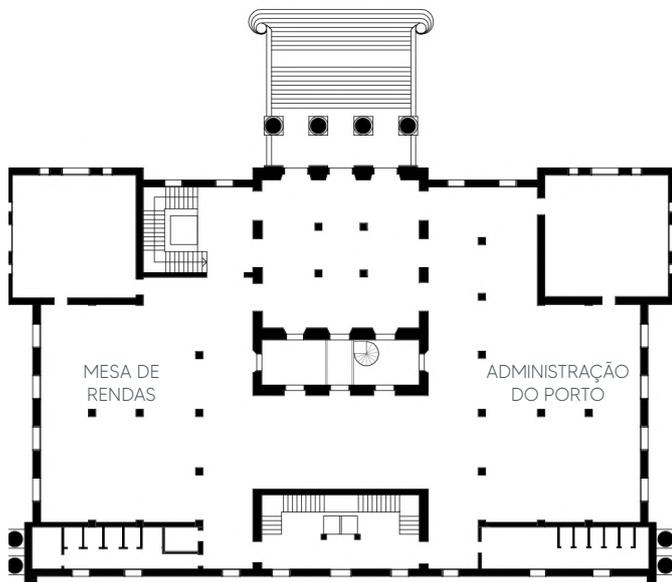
Redesenho planta do 1º andar, Secretaria da Fazenda, 1942.
